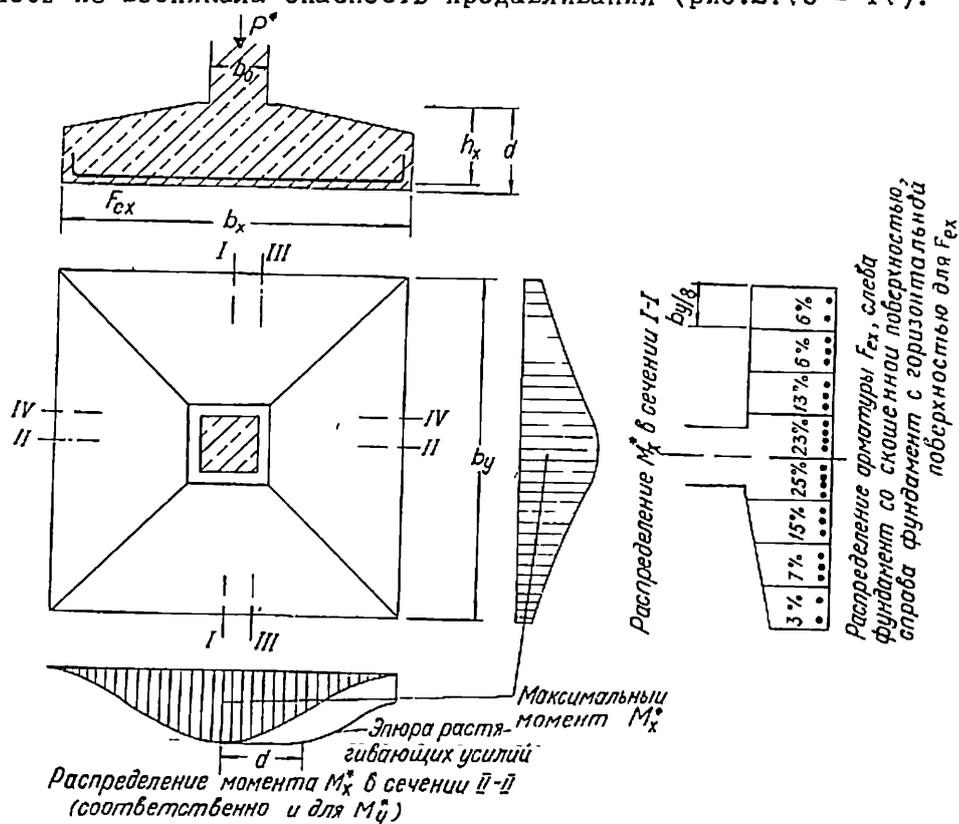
8. Распределение арматуры при центрально нагруженных квадратных отдельных фундаментах по [2.32]
